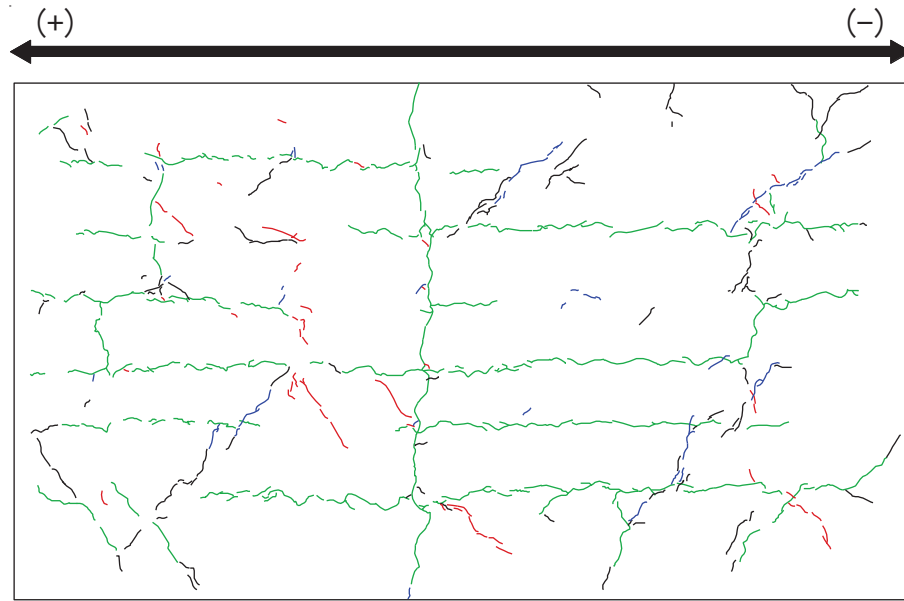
(5) 乾燥試験体 [1] 1/2500rad. におけるひび割れ図
